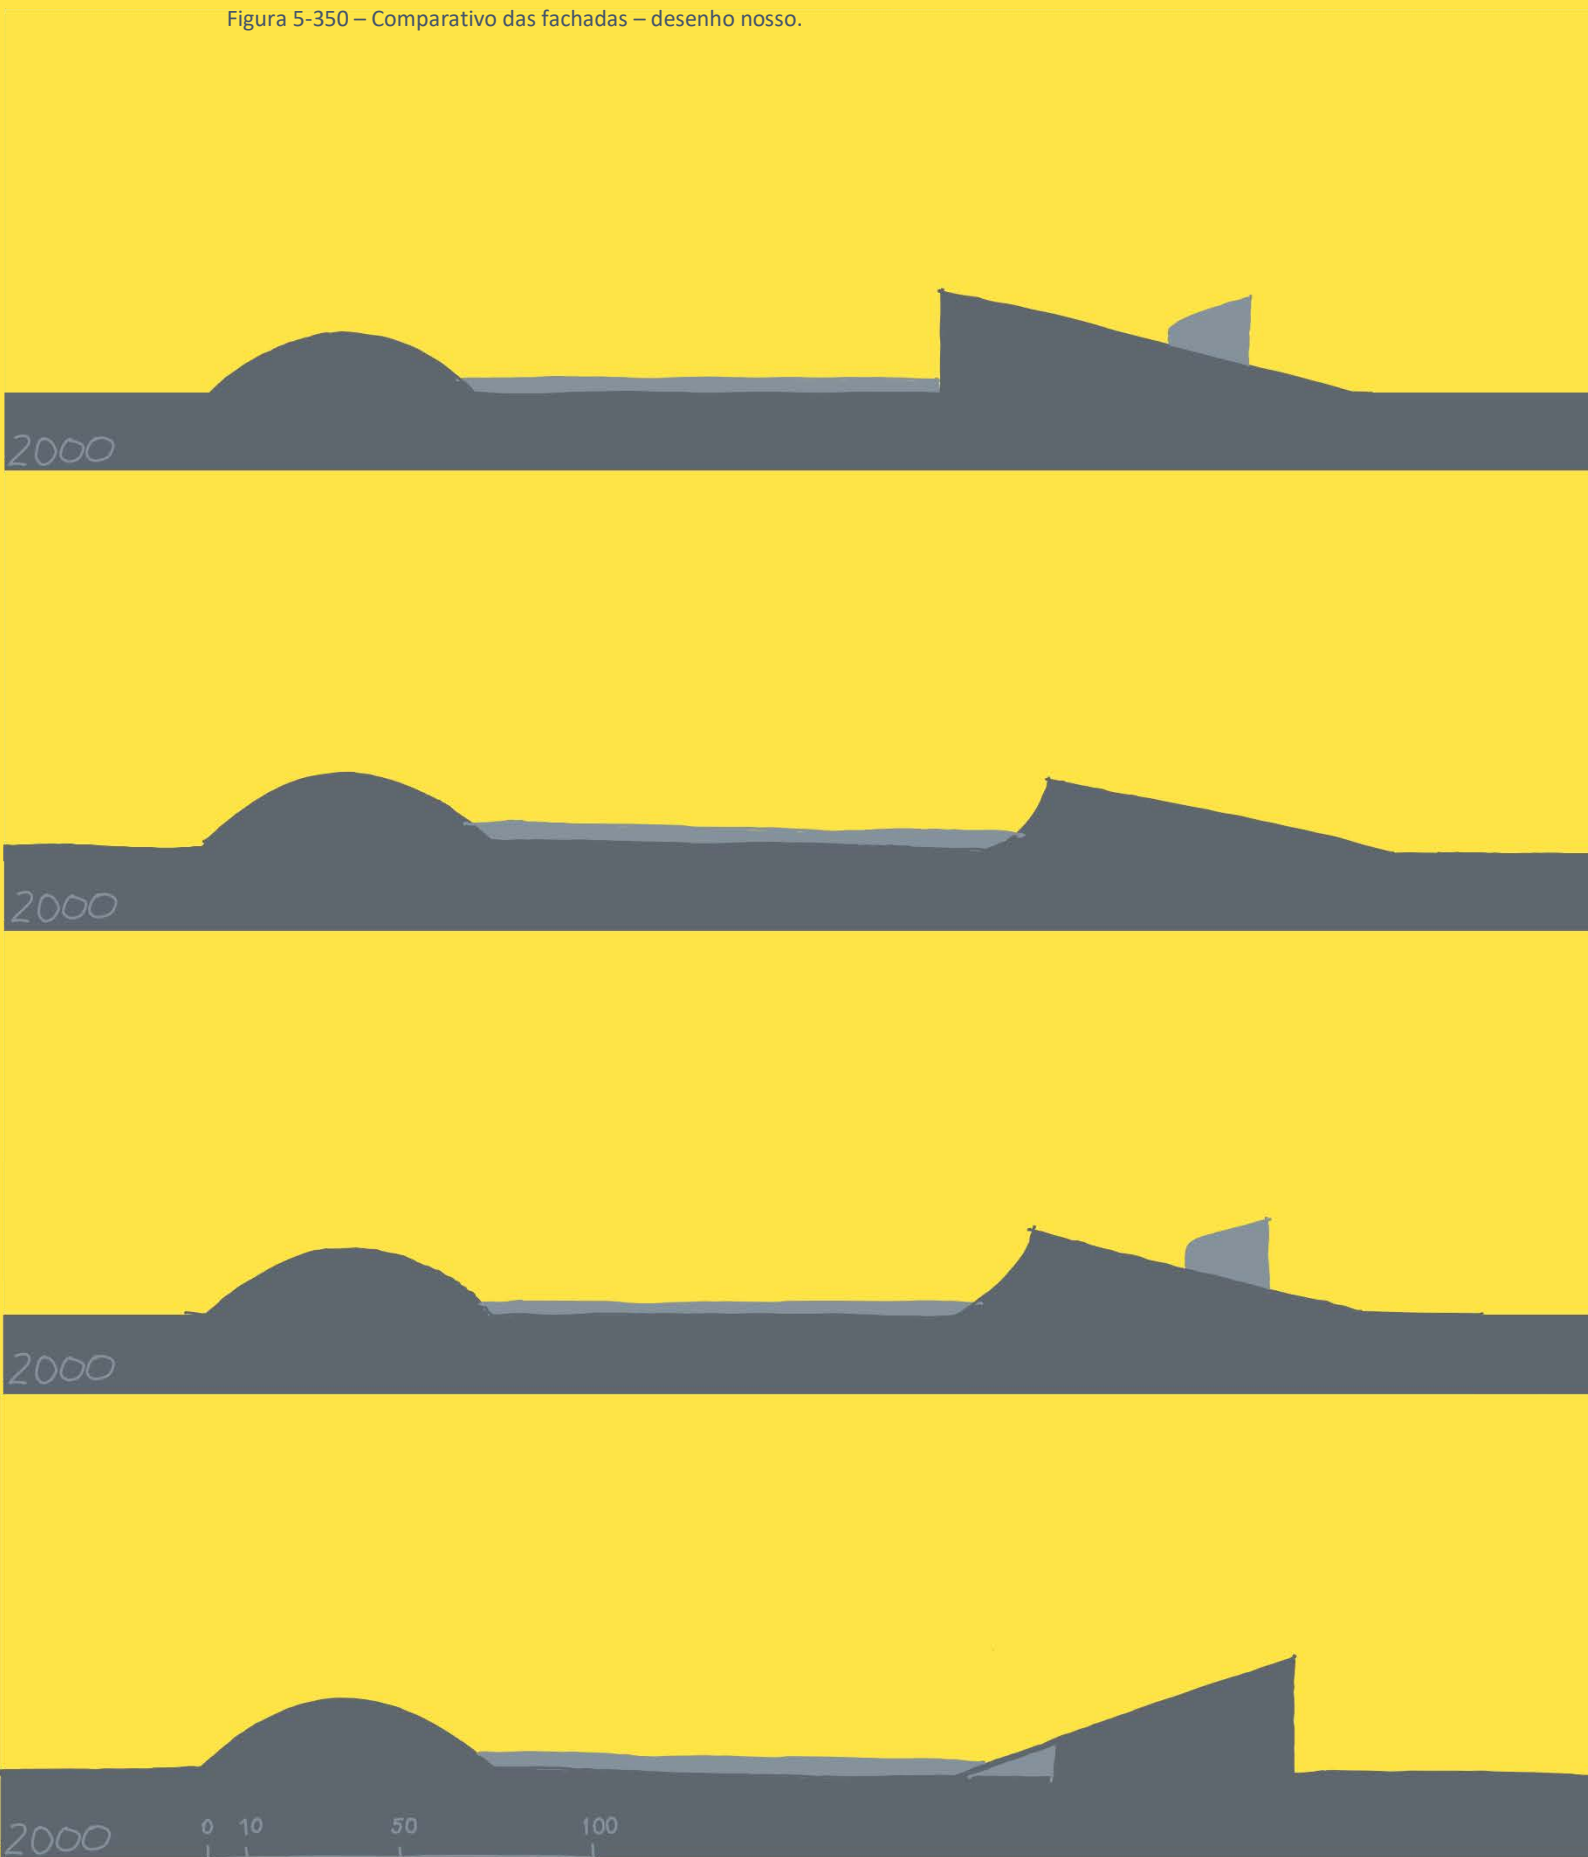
Comparativo das fachadas – desenho nosso.
